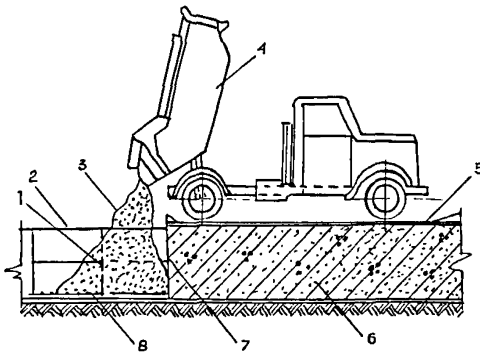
Бетонирование плиты автобетоносмесителями, автобетоновозами или автосамосвалами методом "от себя":
